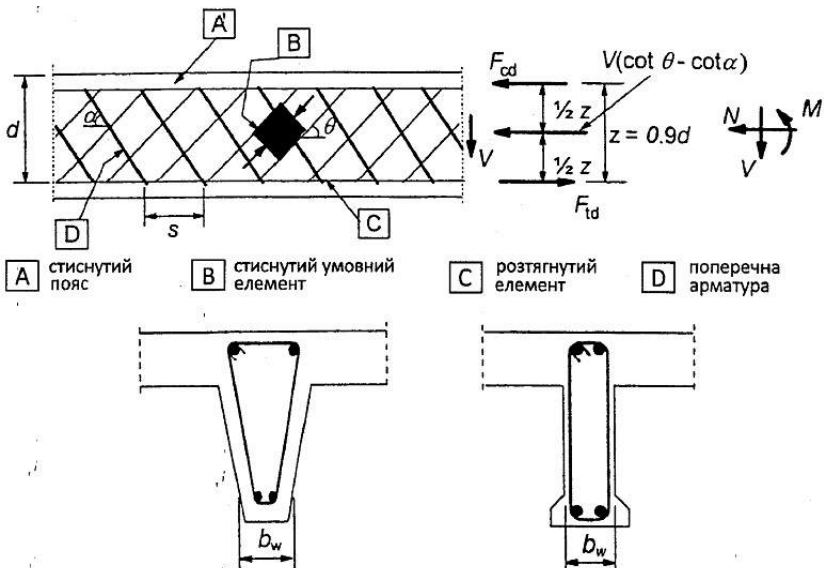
Застосування "фермової" моделі до розрахунку похилих перерізів
